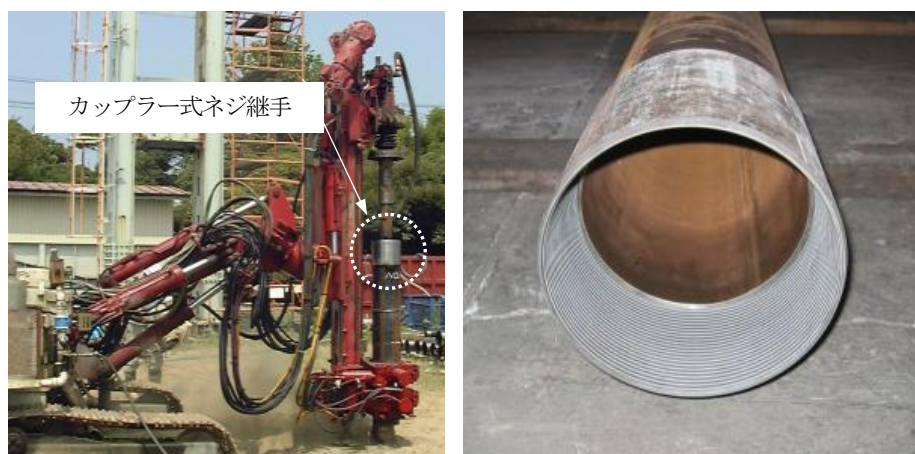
鋼管の機械式ネジ継ぎ手の例（カップラー式ネジ継手）
